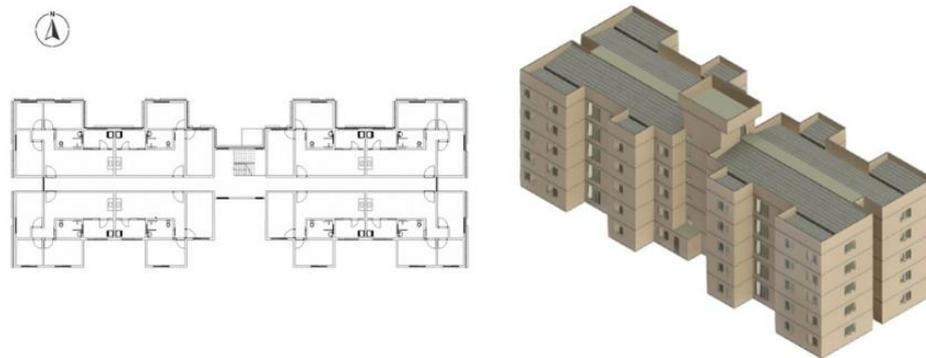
Planta baixa e modelagem 3D do estudo de caso (QUINTANILHA, 2023)
